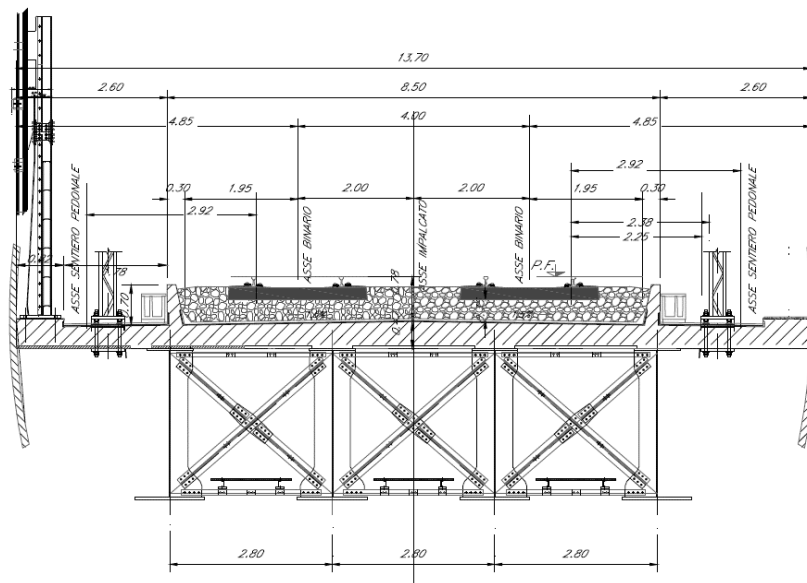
Sezione tipo - Impalcato a struttura mista acciaio calcestruzzo a doppio binario
